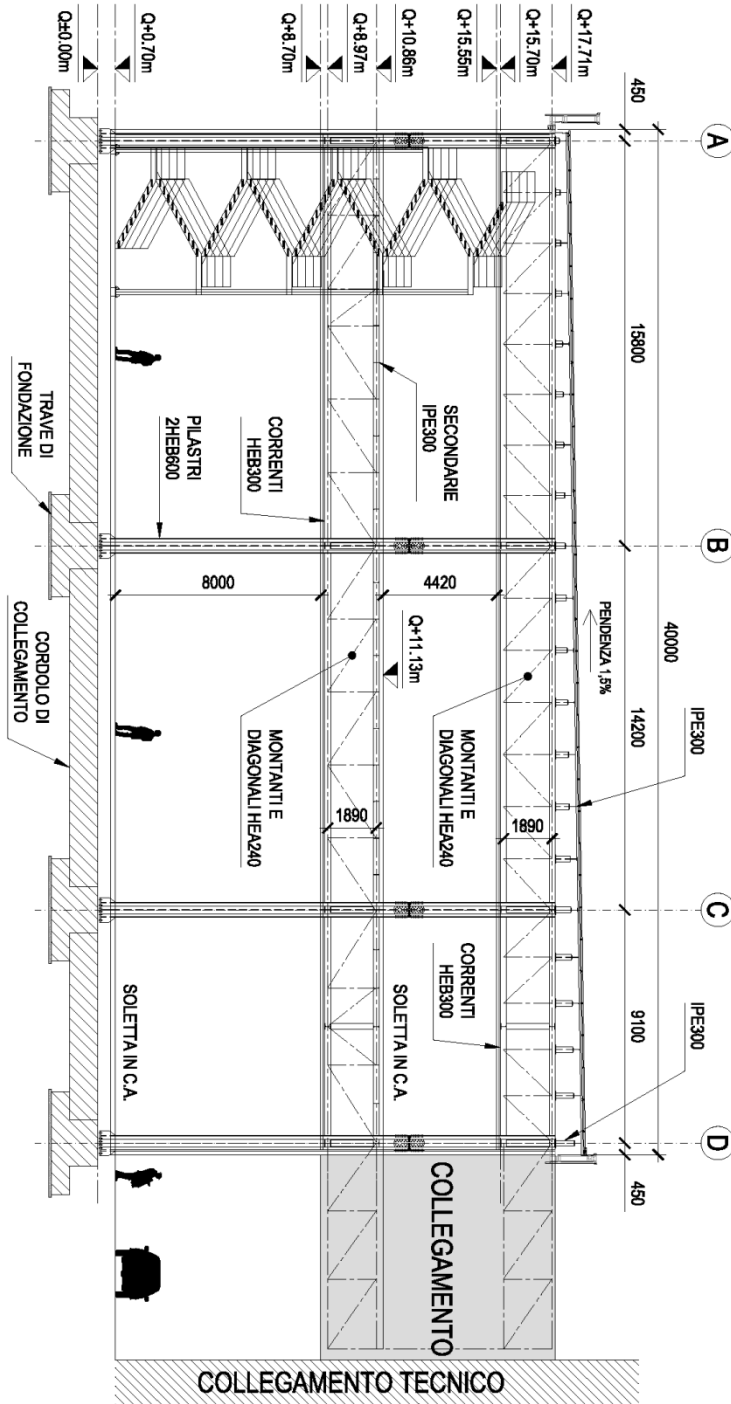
Sezione trasversale tipo struttura di elevazione
